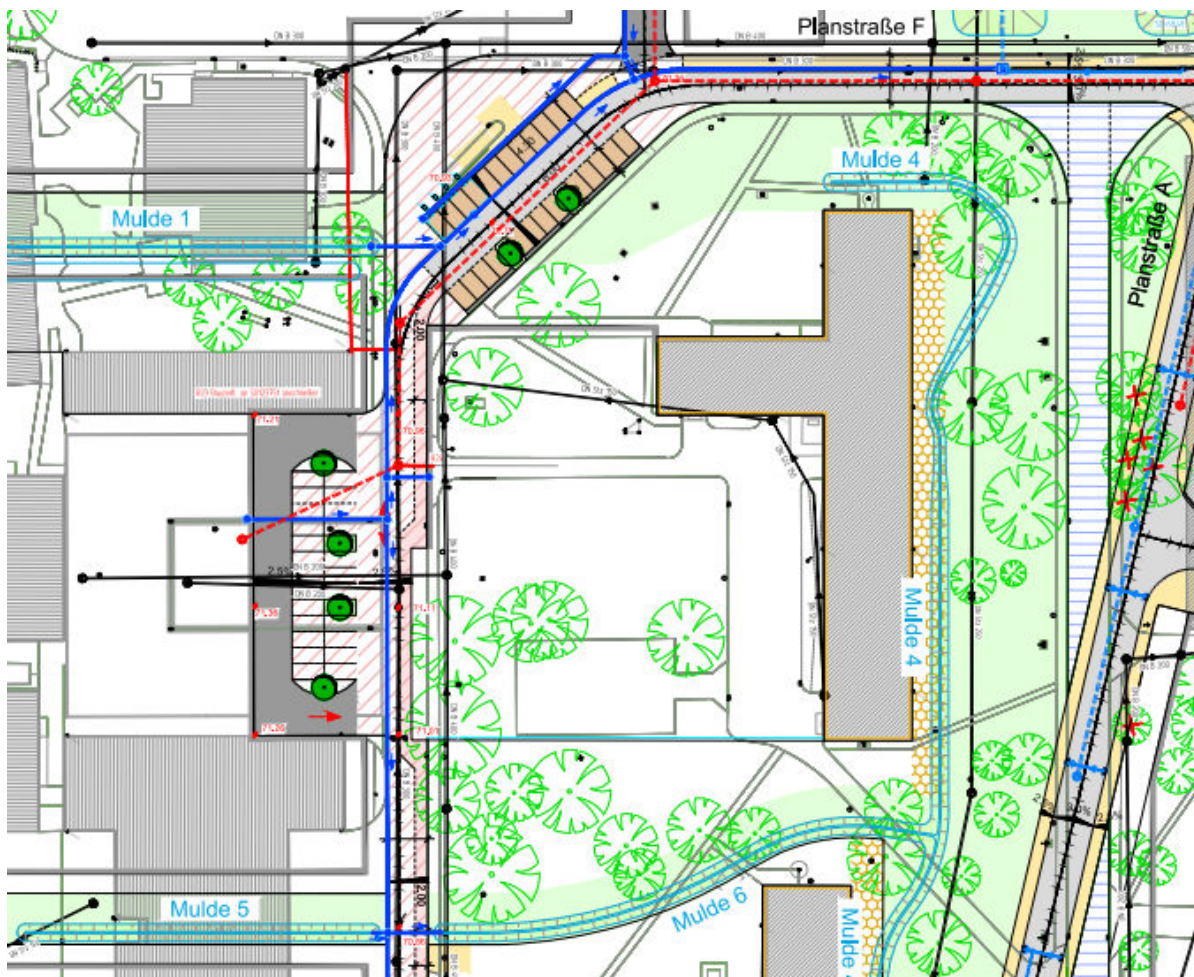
Erschließung Baufeld D2 (Stadt Münster)
